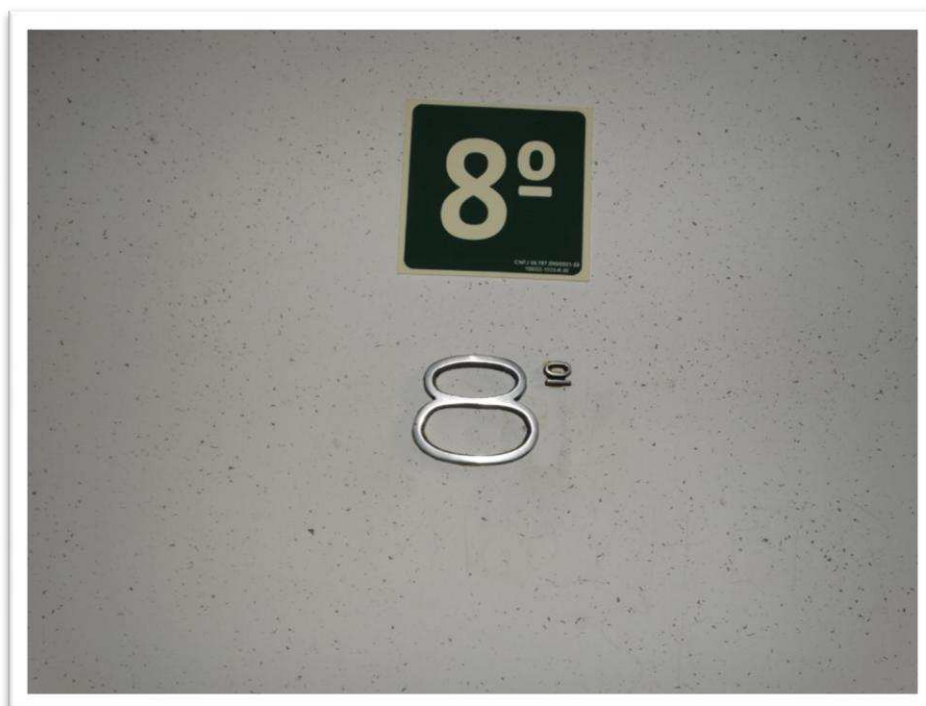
Vista da identificação do pavimento, na caixa de escada do Bloco “B”.
